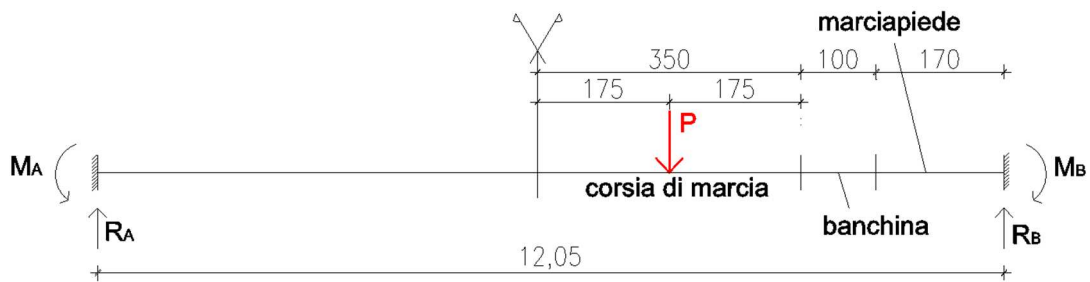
Schema sezione trasversale ponte ad L/2
